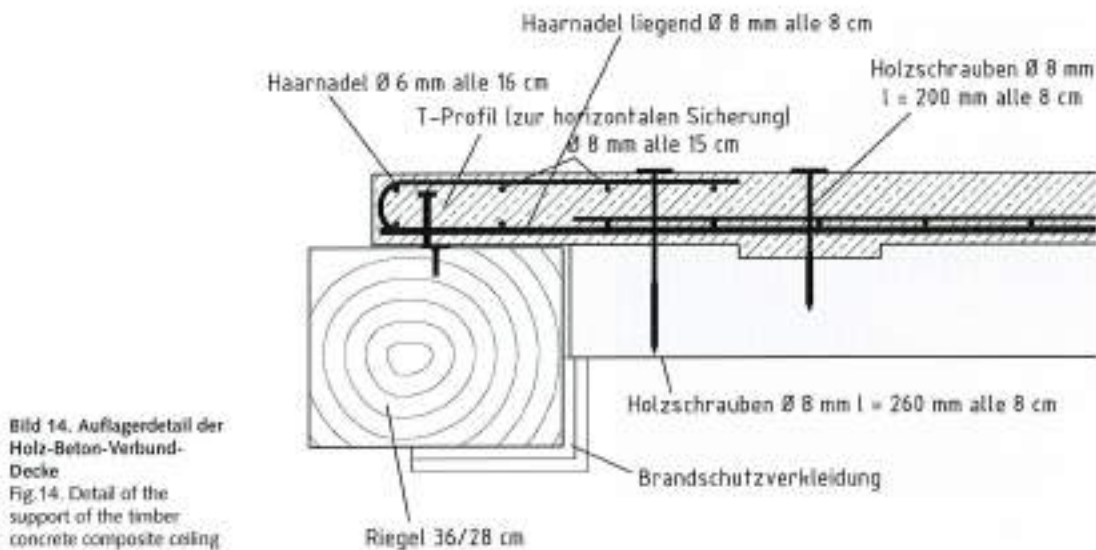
Auflagerdetail der Holz-Beton-Verbund-Decke
